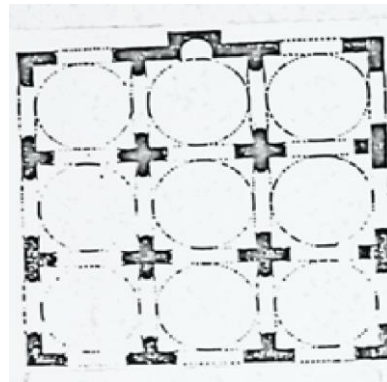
مسقط أفقي للجامع العتيق أو
